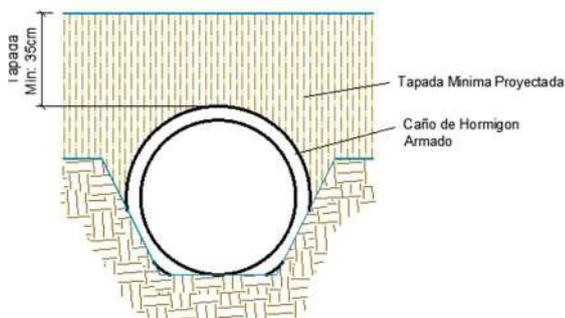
Detalle de alcantarilla paralela a calles pavimentadas
